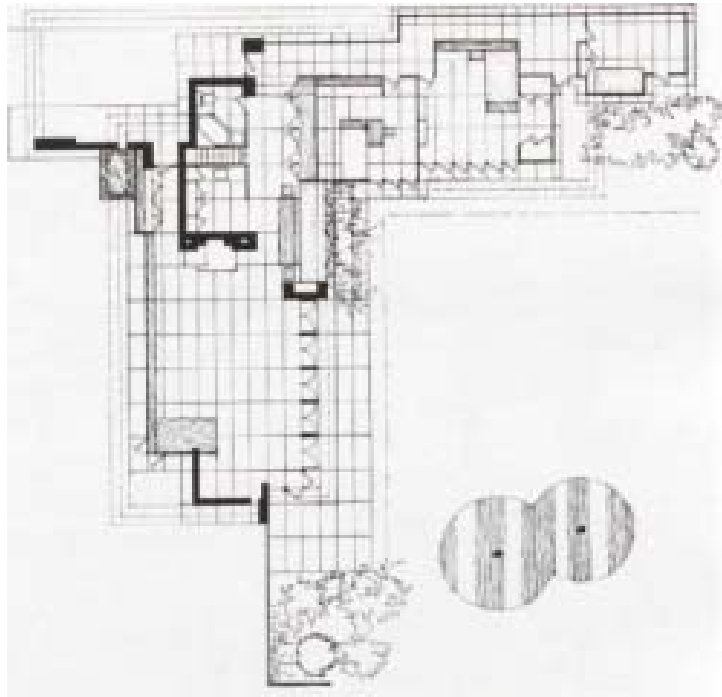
Planta da *Jacobs House*. Fonte: Sergeant (1984)
